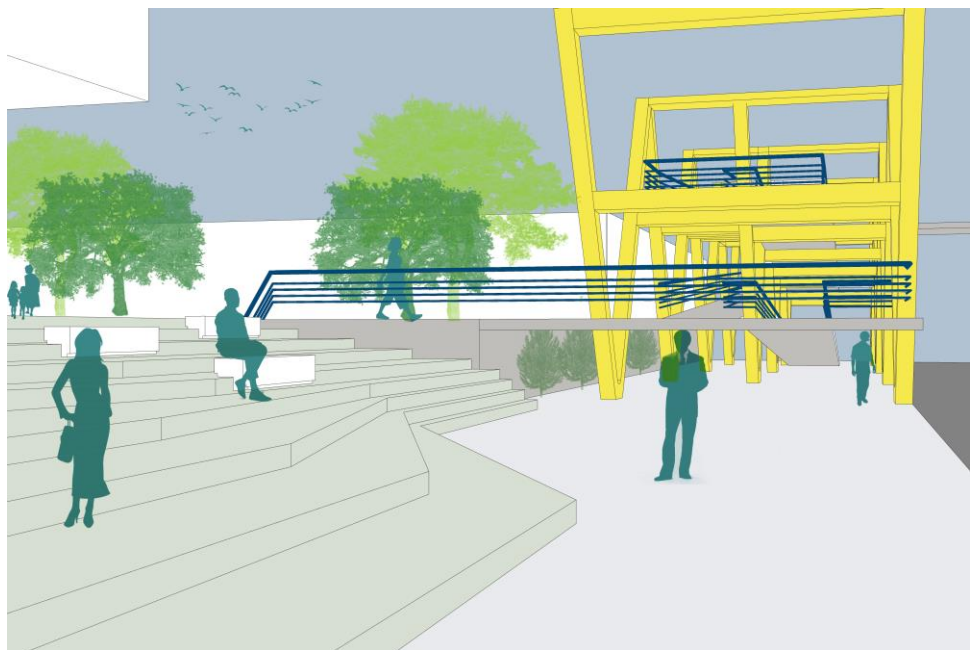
Visão da calçada Av. Djalma Batista. Fonte: acervo da autora, 2021
